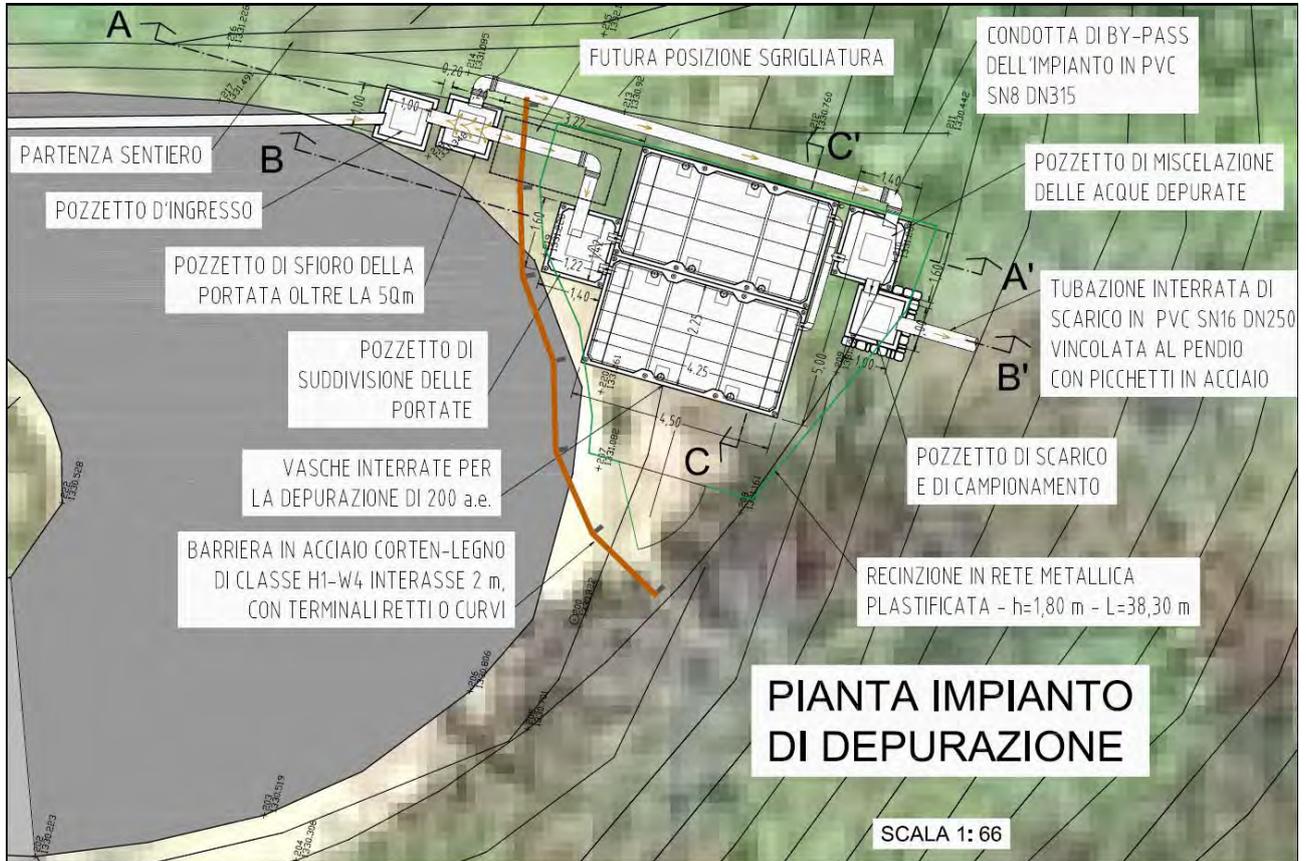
Estratto da Progetto: planimetria impianto di depurazione.
